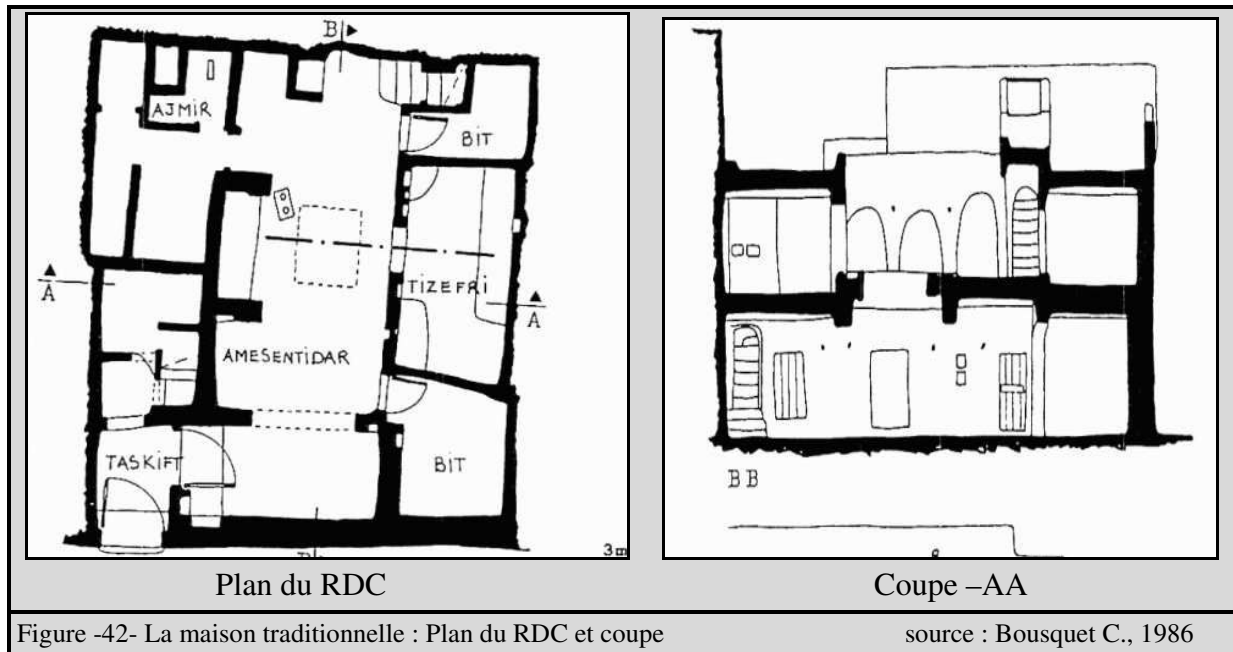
La maison traditionnelle : Plan du RDC et coupe
